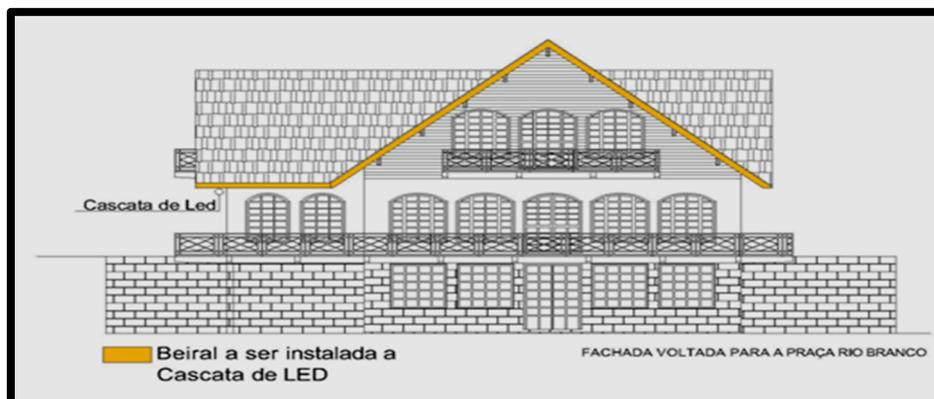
Localização dos beirais de instalação da Cascata de Led na Fachada voltada para a Praça Rio Branco
